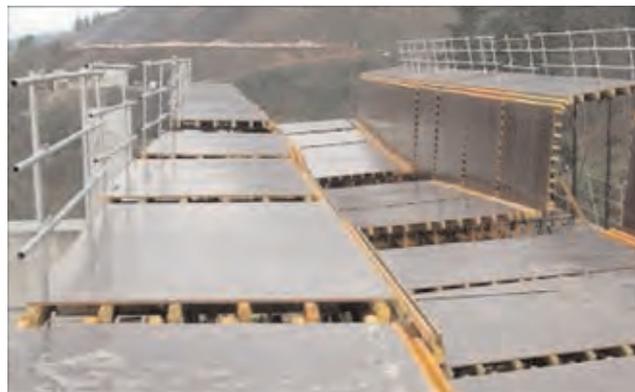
Montaje de encofrado premontado en el suelo con barandillas integrales
